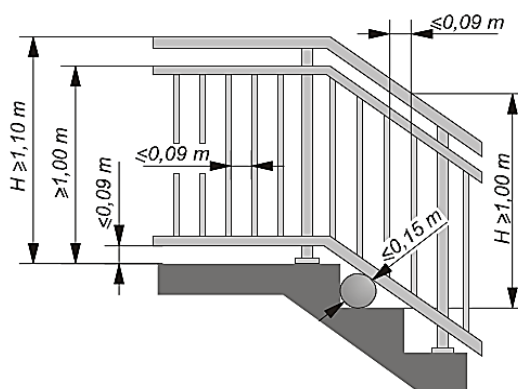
Guardas em escadas ou rampas (IPQ, 2009)
